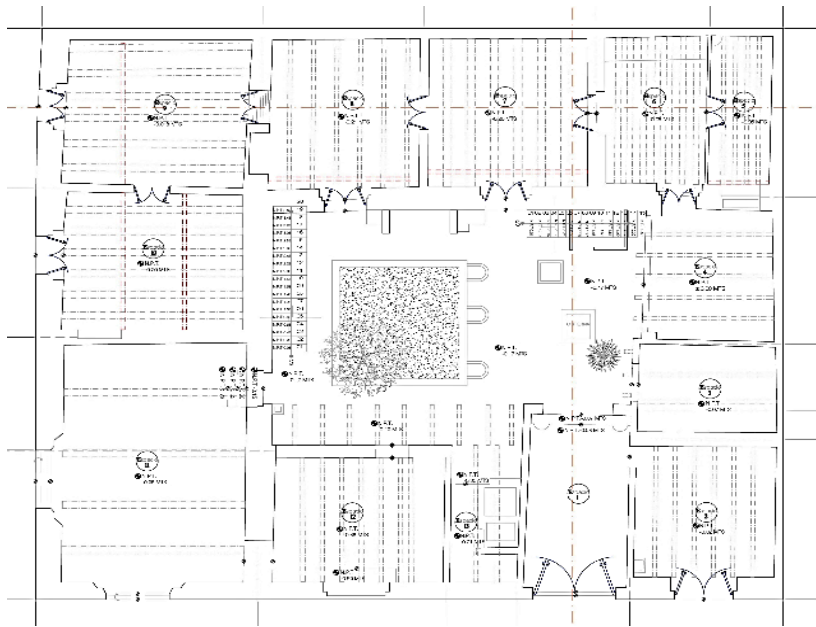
Planta Arquitectónica Baja del inmueble en estudio. Distribución de las habitaciones por medio de un patio central.
